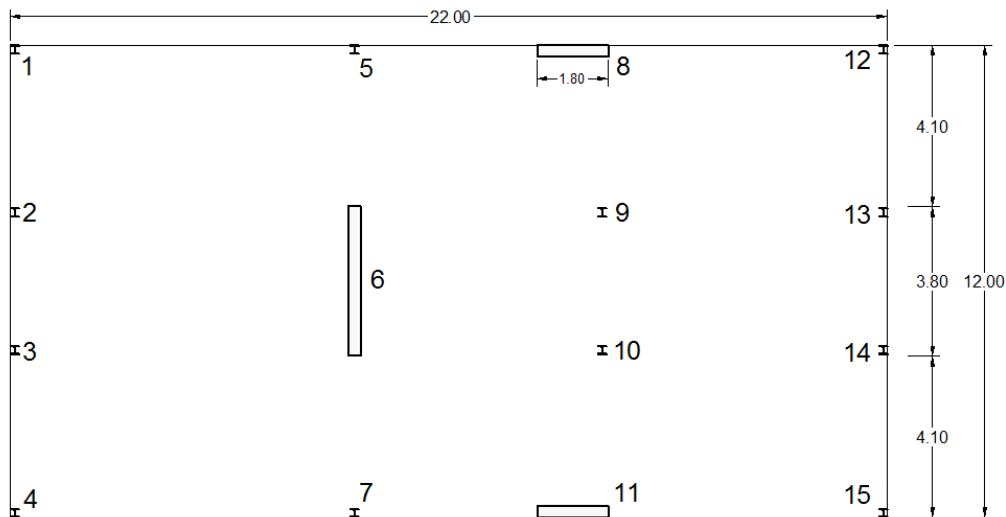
n Esquema planta cimentaciones arquetipo IV
